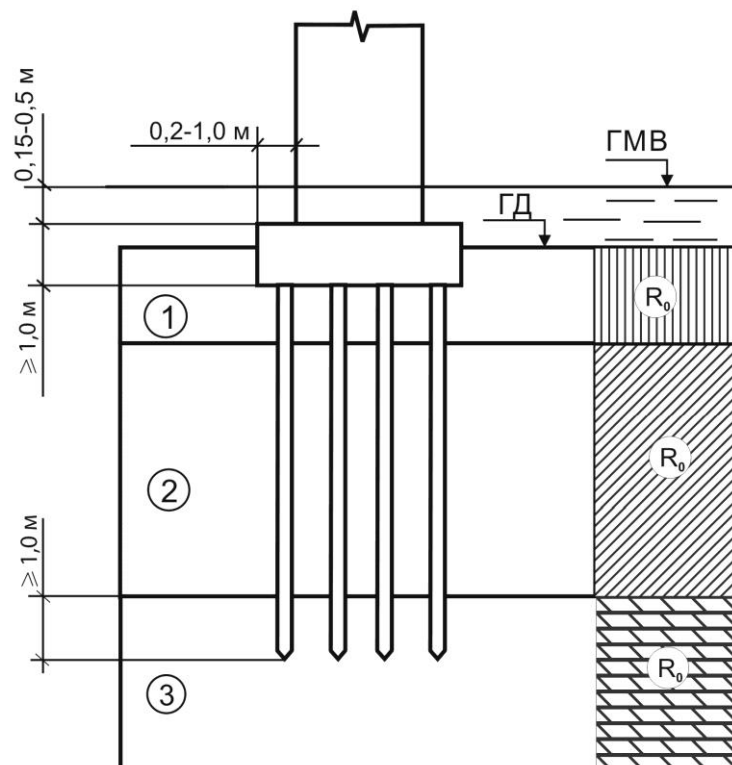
Конструкція пального фундаменту з низьким ростверком
